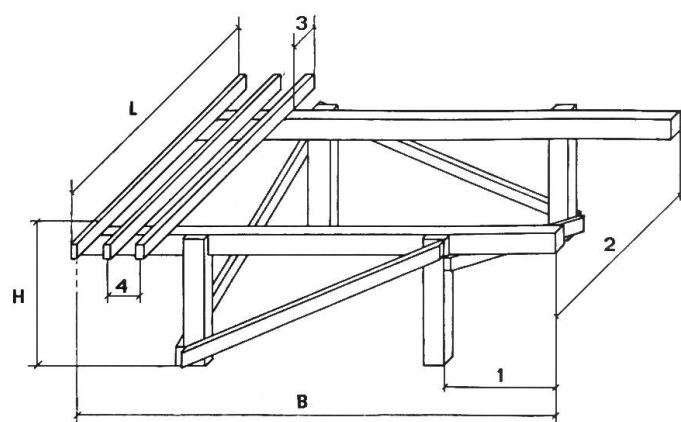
Dessin schématique montrant le mode de construction d'un élément de plancher à claire-voie.
